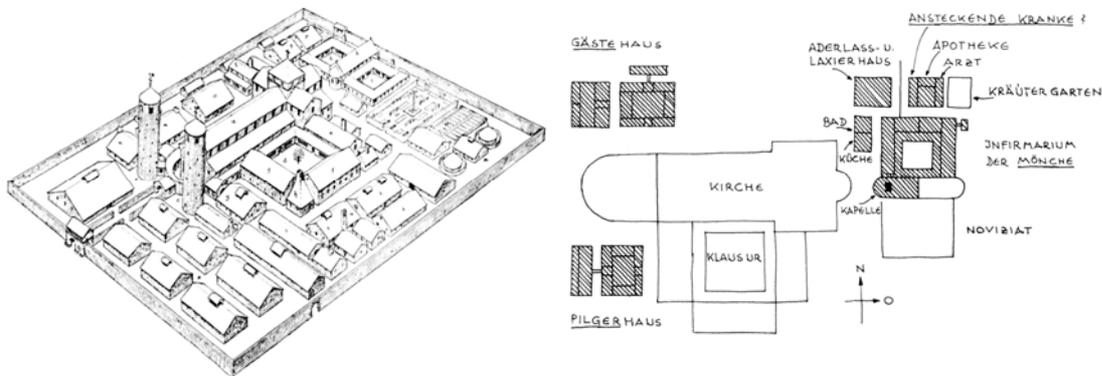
St. Gallener Plan mit Kennzeichnung der Funktionen^{75/76}
